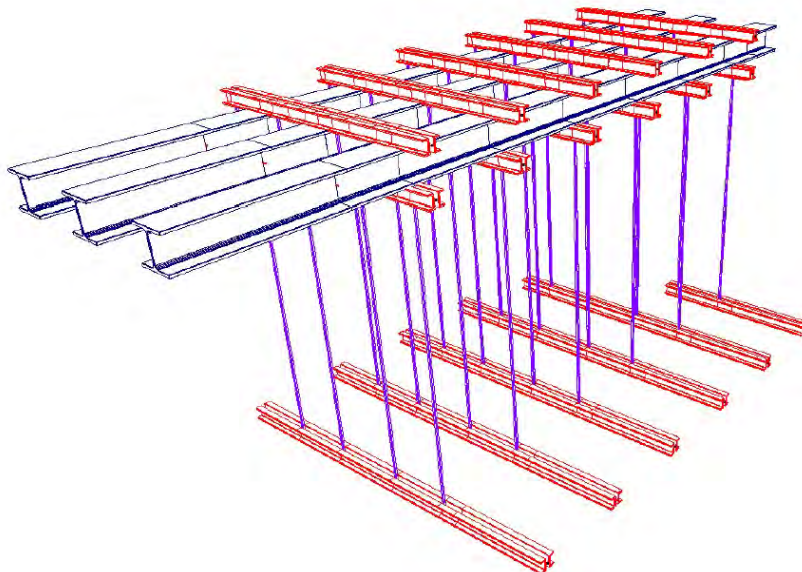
Superestructura sección 2. Sistema de soporte. Fuente: SATO (2020)
